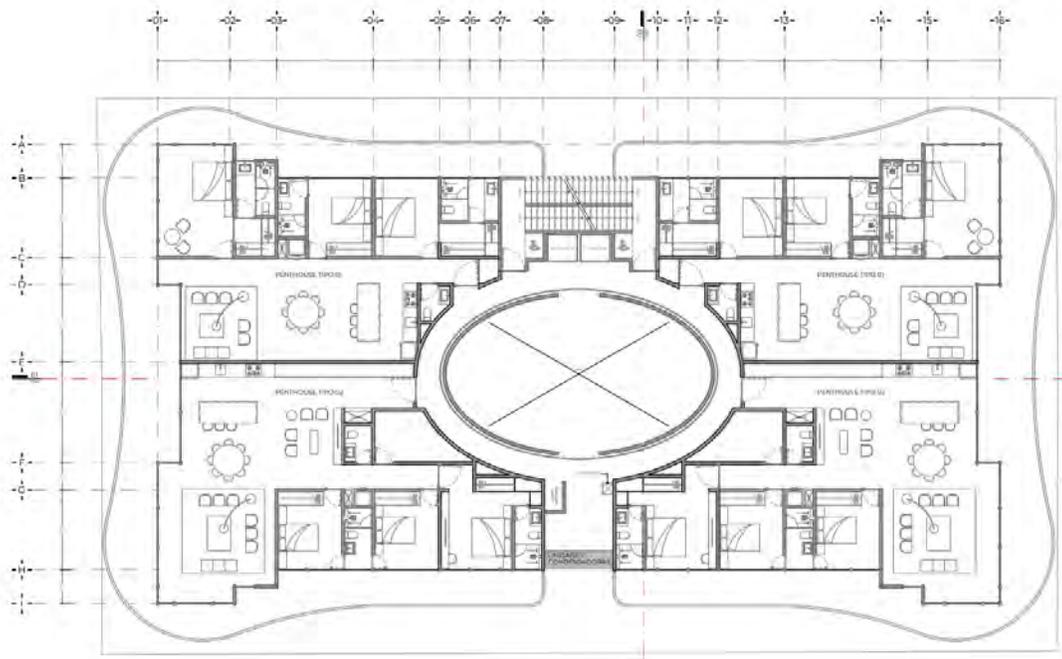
Plano del diseño del nivel 12 para los Penthouse IKonic Tower.
